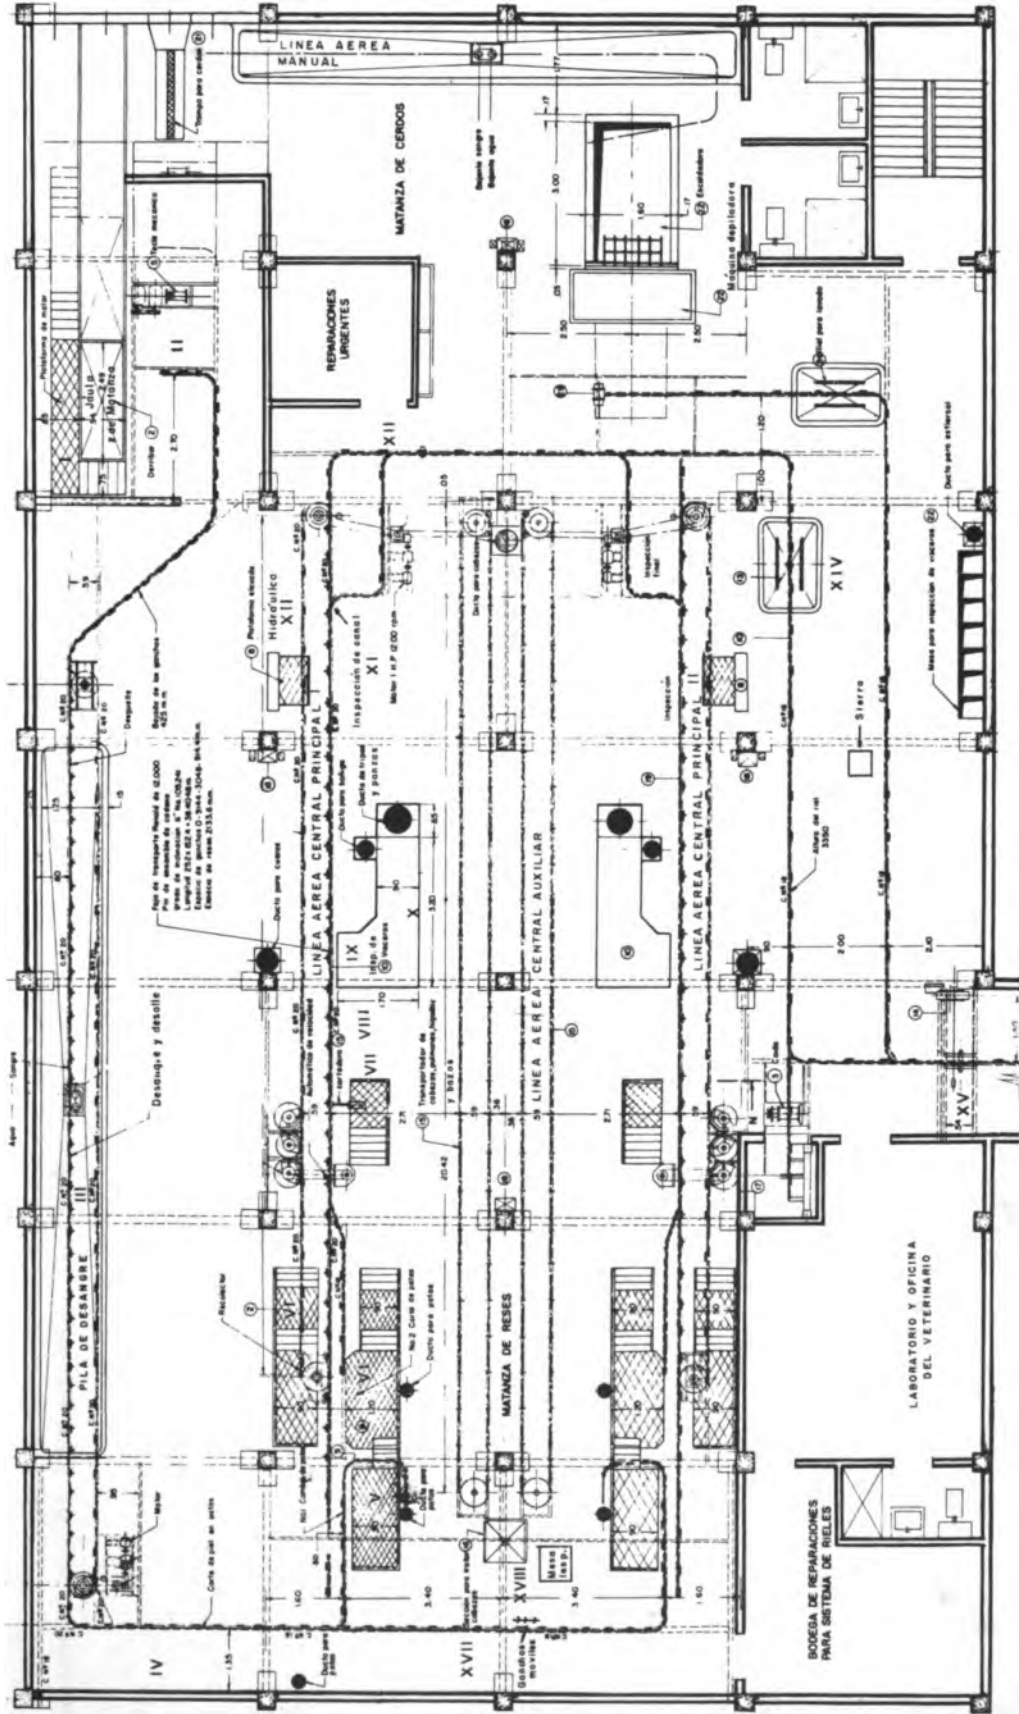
CMNM: PLANO DE LA SALA DE MATANZA, PLANTA ALTA, (Modificado) Fuente: Rodríguez Vargas. (21)
